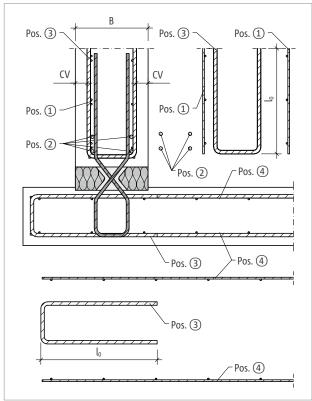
Schöck Sconnex® Typ W-N-VH: Variante A – bauseitige Bewehrung für Anschluss am Wandfuß
